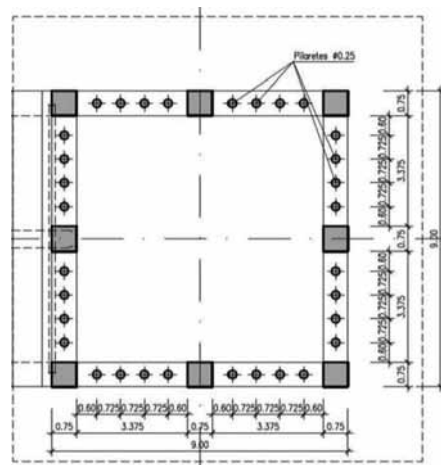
Esquema em planta da torre de tomada de água (retirado do Projecto de Execução; s/ escala).
